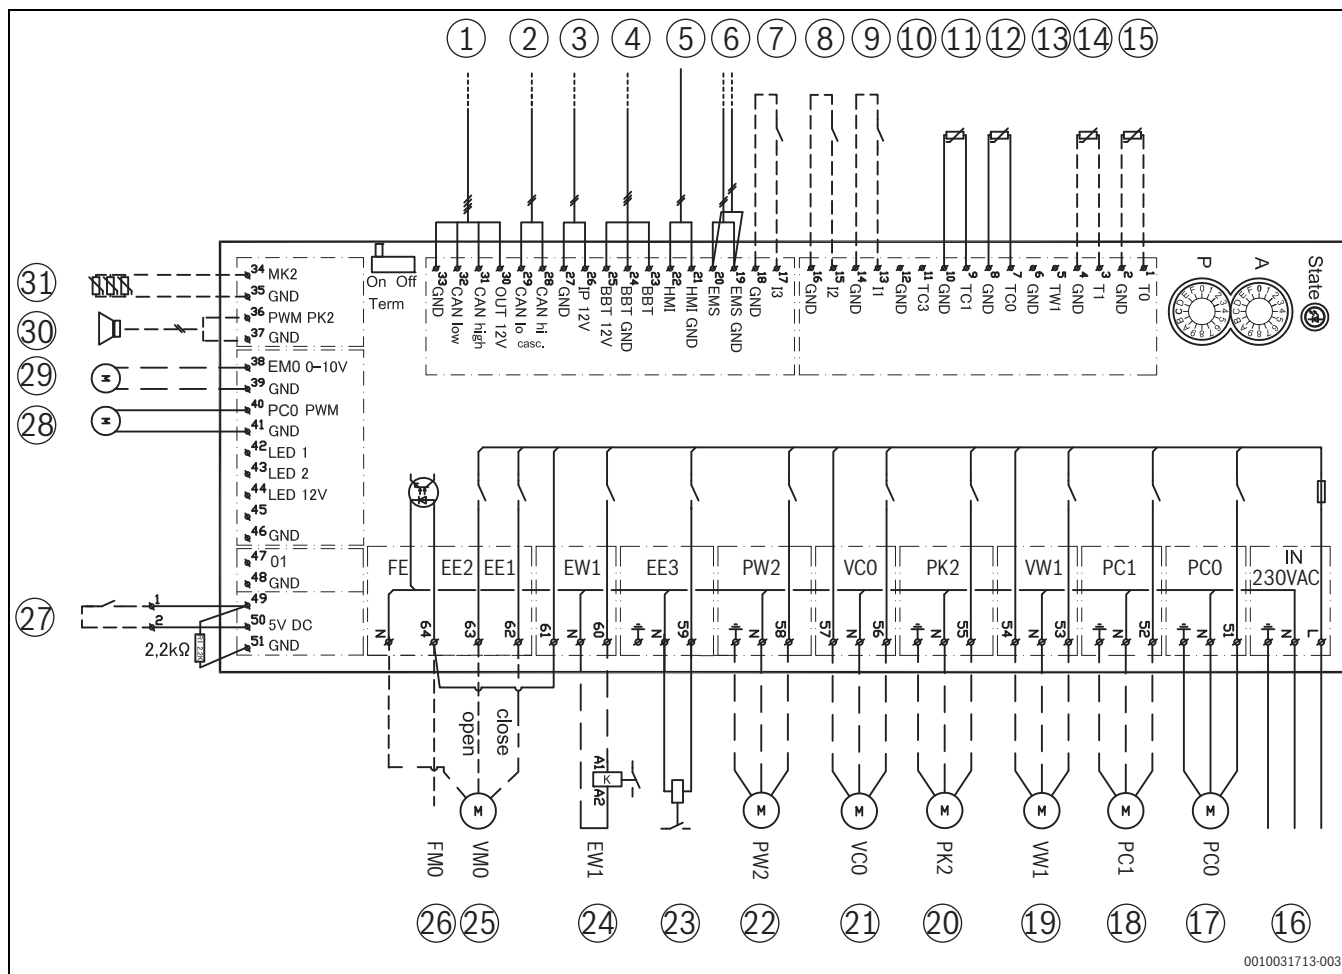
Schema elettrico di collegamento del modulo di installazione
